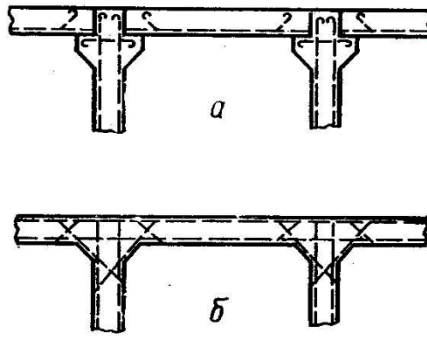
Опираие плоских напорных плотин на контрфорсы: *a* – разрезное; *б* – неразрезное
